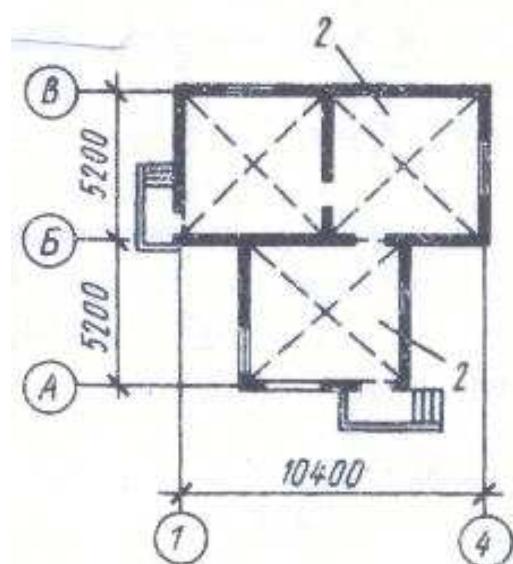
Конструктивные схемы с коробчатым остовом (2 – плиты перекрытия на комнату, опираются по четырем стенам)
